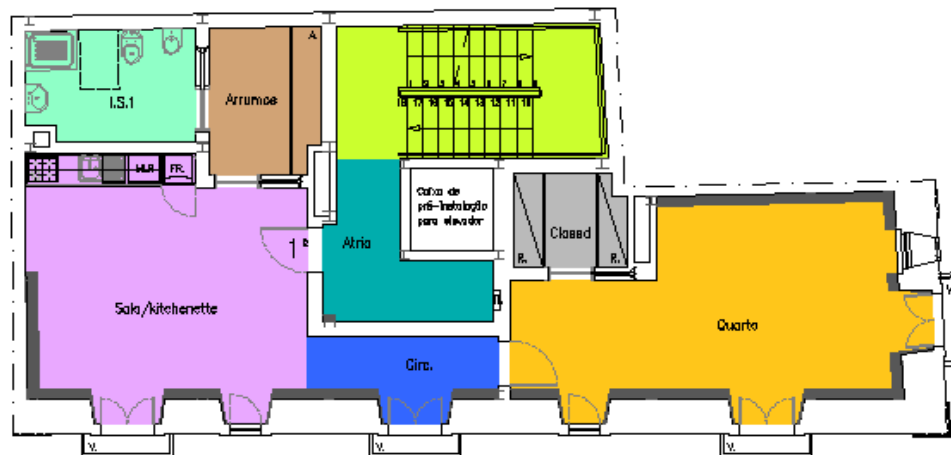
Planta do Piso 1 (Fonte: Projeto de Arquitetura)
